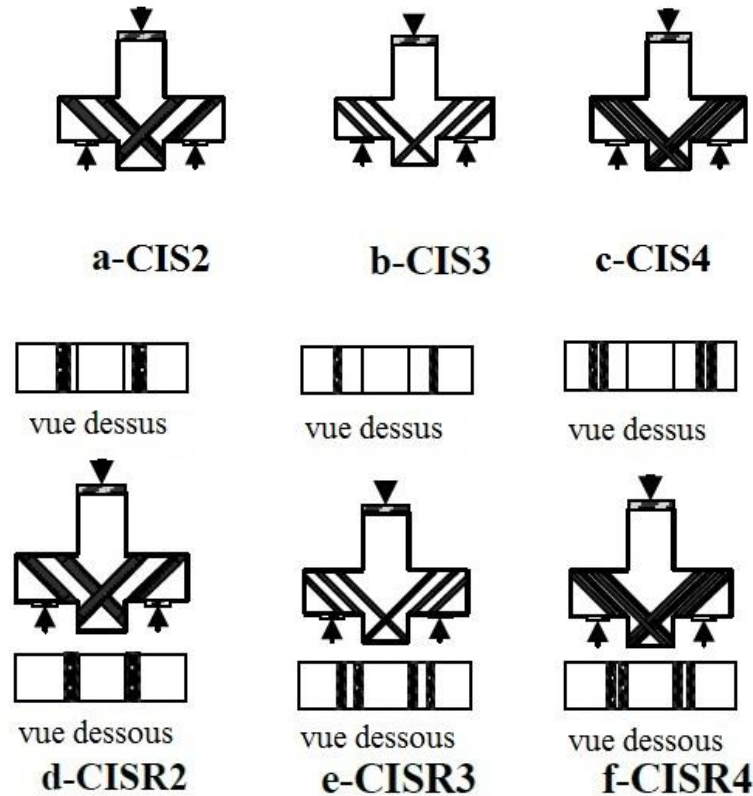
Détails d'autres types de renforcement [ANI 12]
